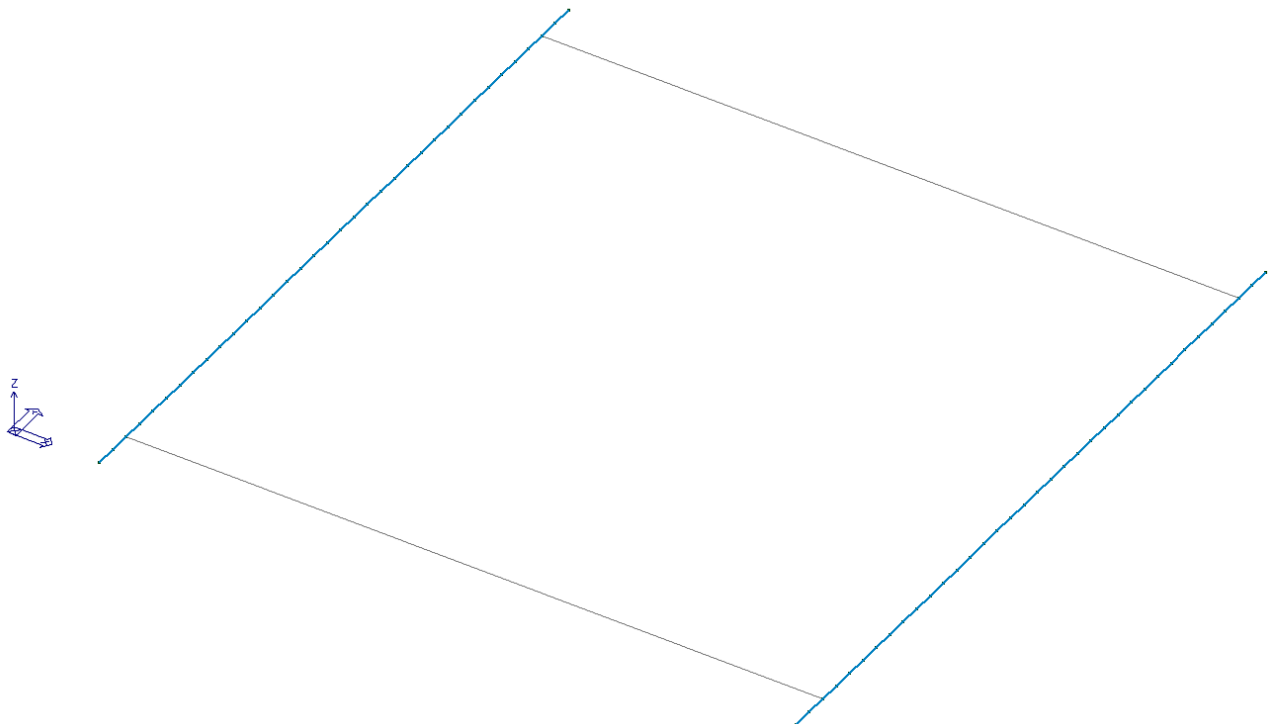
Schema unifilare della fondazione (Verifiche strutturali)
